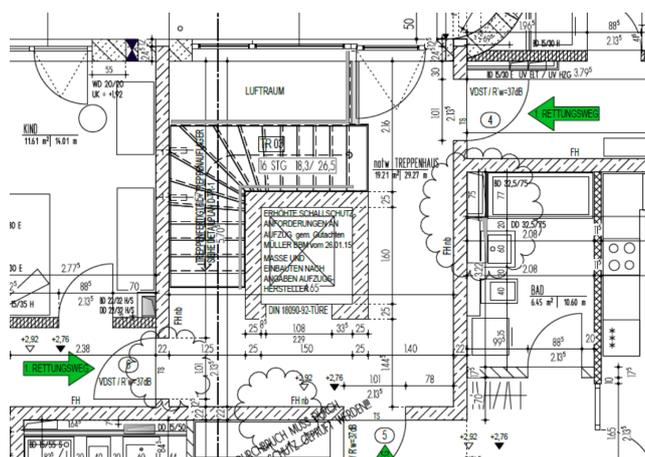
Grundrissauszug – Schalltechnisch günstige Anordnung des Aufzugschachtes im Treppenauge.
